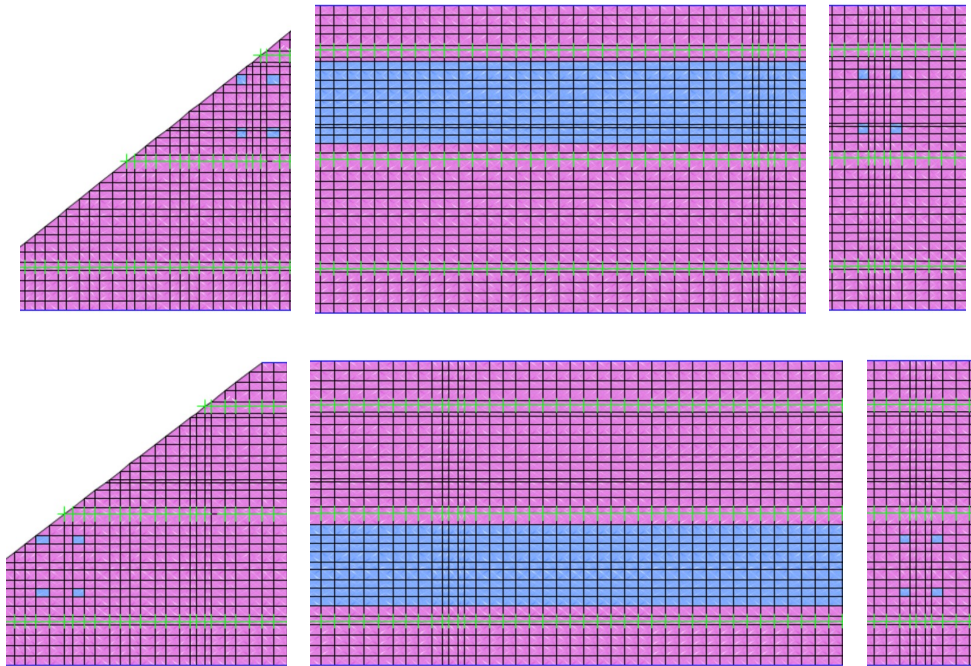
Posizione delle corsie e dei carichi tandem nella prima disposizione SLU1.2
